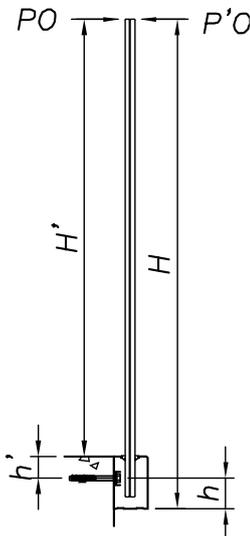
Dimensionnement des chevilles fixation nez de dalle
